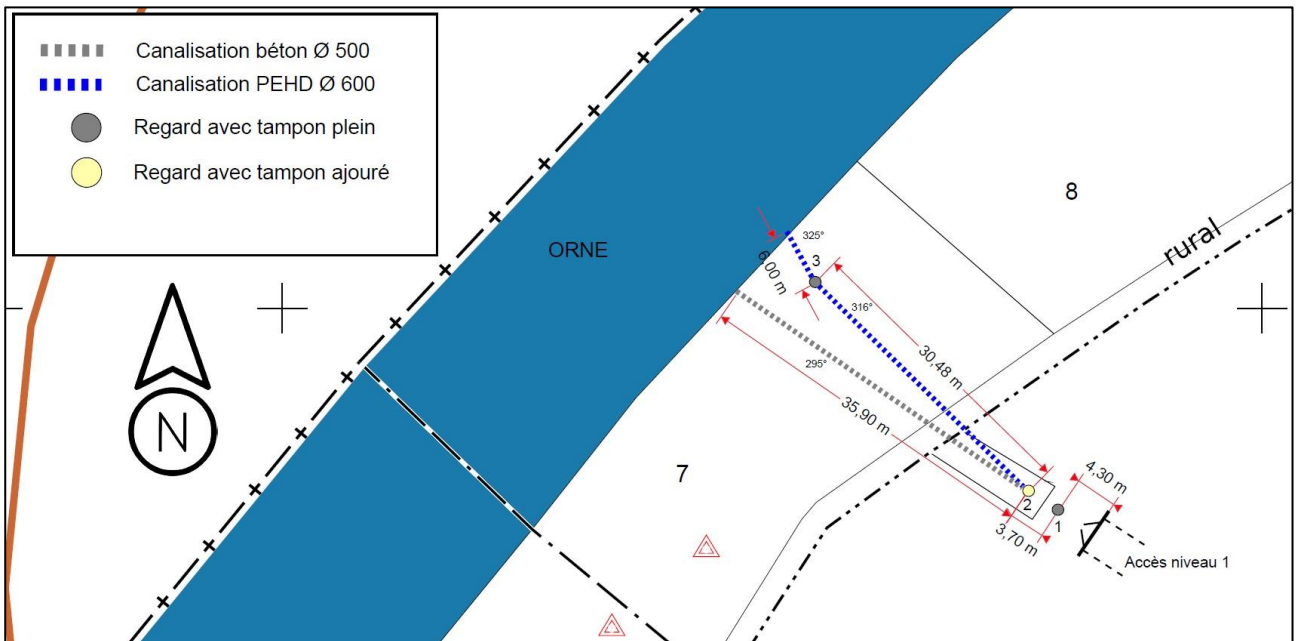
Vue en plan et en coupe des travaux réalisés sur l'exutoire du flanc sud.
